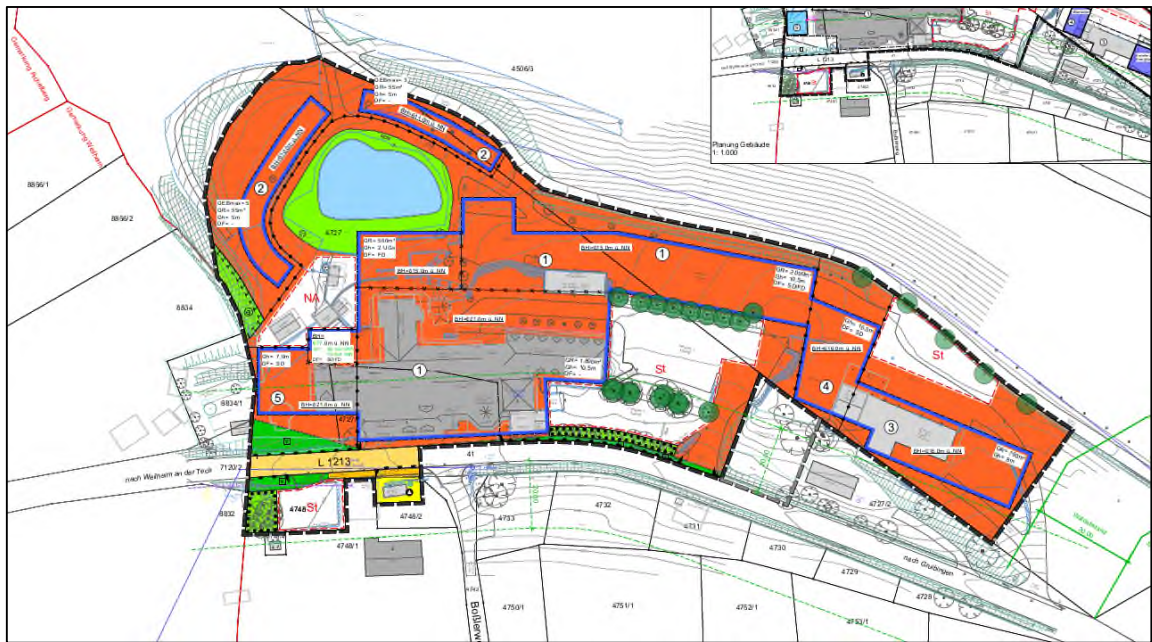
Entwurf zum Bebauungsplan ‚Kaltenwang‘, Stand: 10.01.2024 [29]
